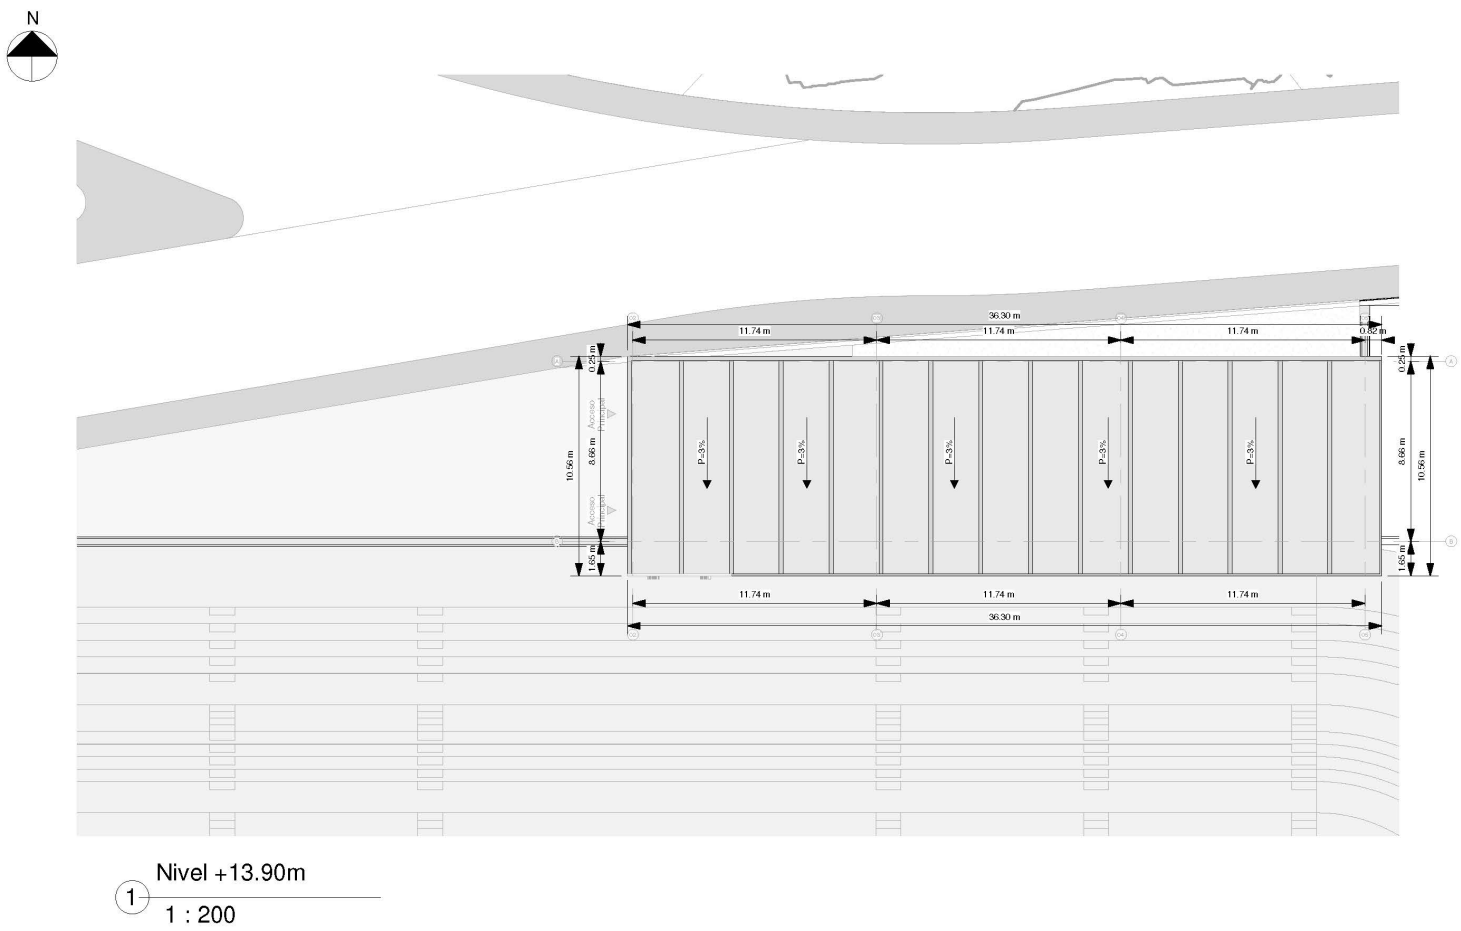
Bloque posterior. Elaboración: Autores.
